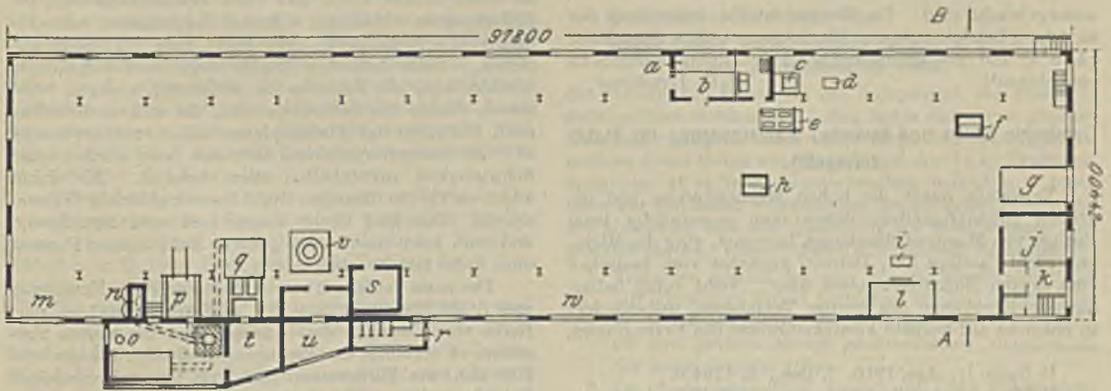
Grundriß der Stahlgießerei mit elektrischem Schmelzbetrieb.
